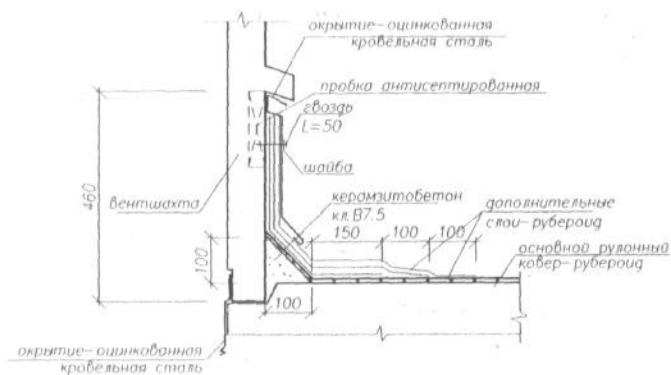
Примыкание кровли к вентиляционному отверстию
